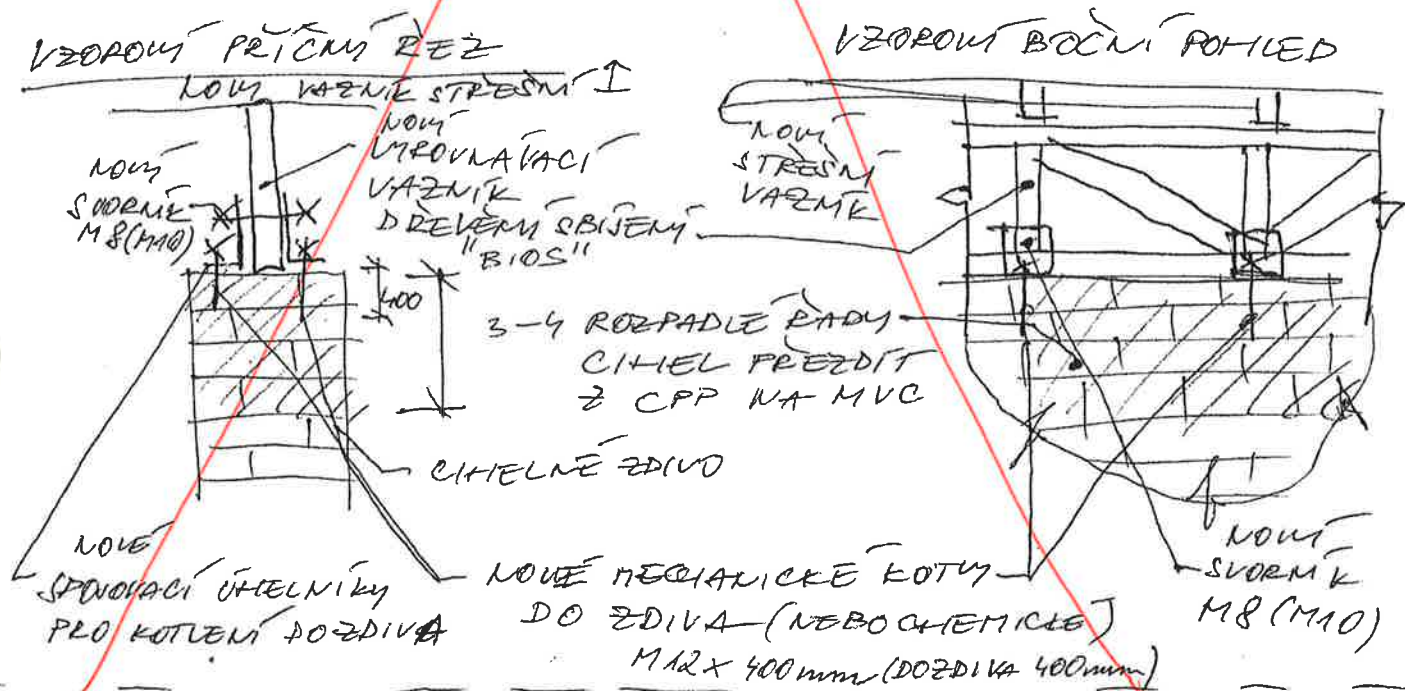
# DETAIL ULOŽENÍ VAZNÍKŮ NA ZDIVO
